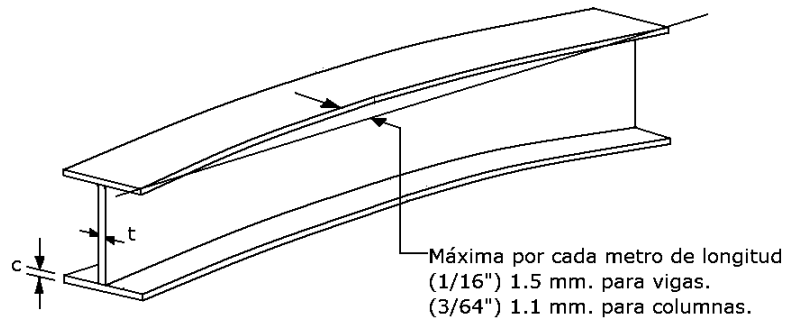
Vigas formadas con tres placas soldadas
